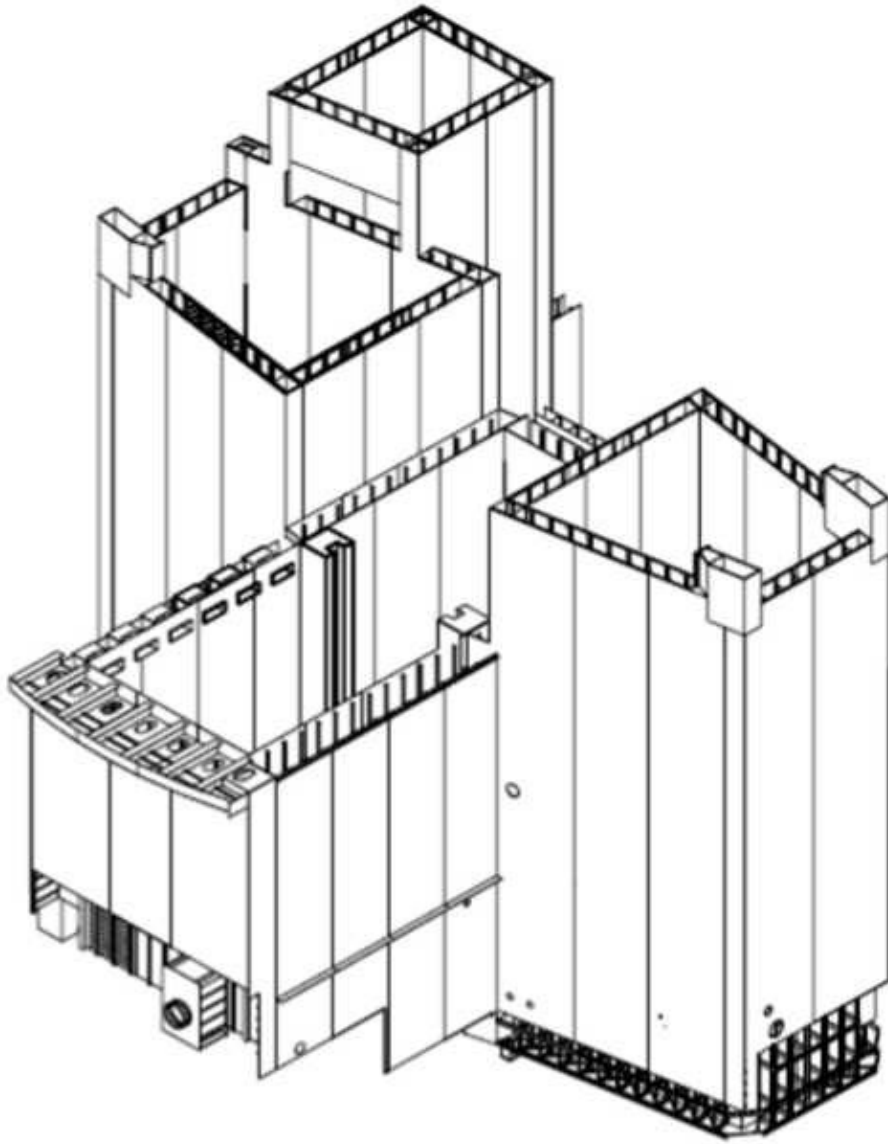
Монтажный блок строительных конструкций для АЭС проекта AP-1000.
